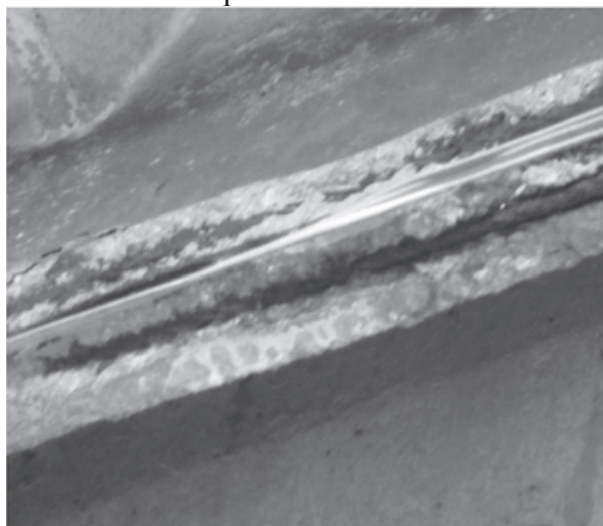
Руйнування захисного шару, оголення та корозія поздовжньої арматури плити покриття
